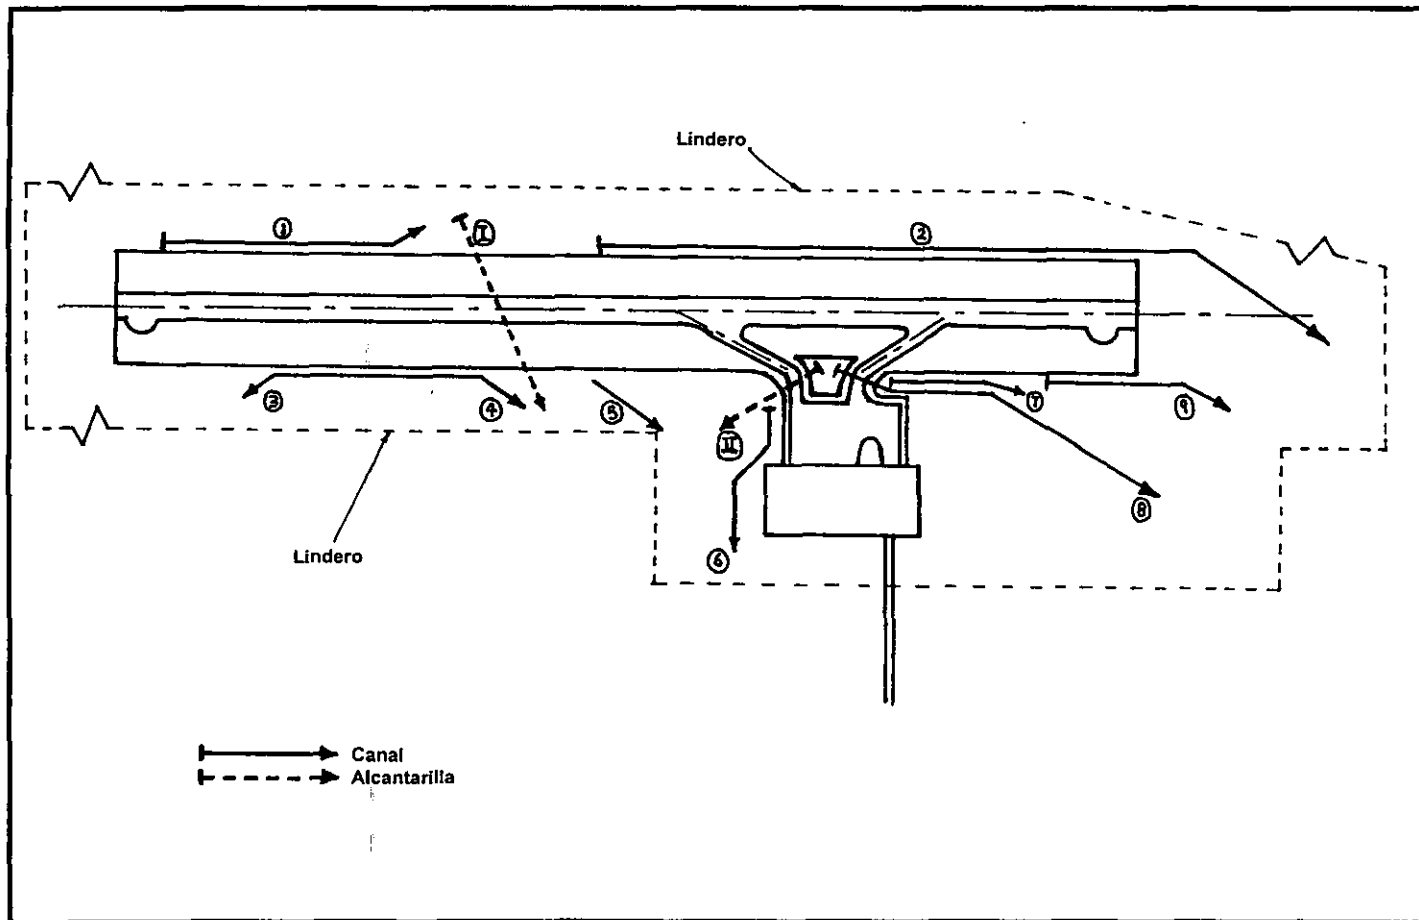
Obras de drenaje típicas en un aeropuerto.
